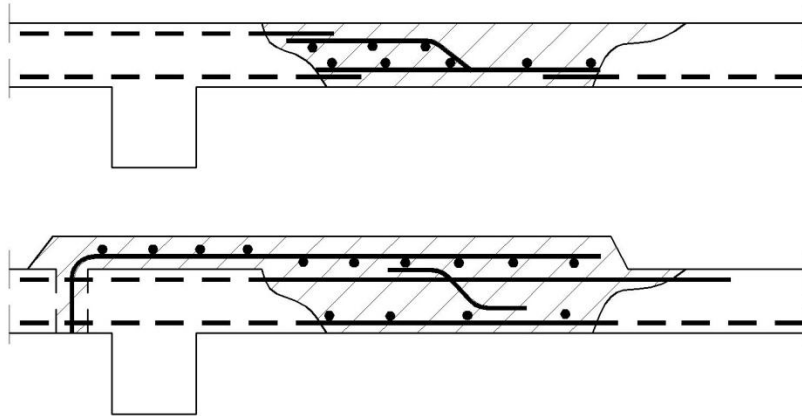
Consolidarea locală a plăcilor planșelor
